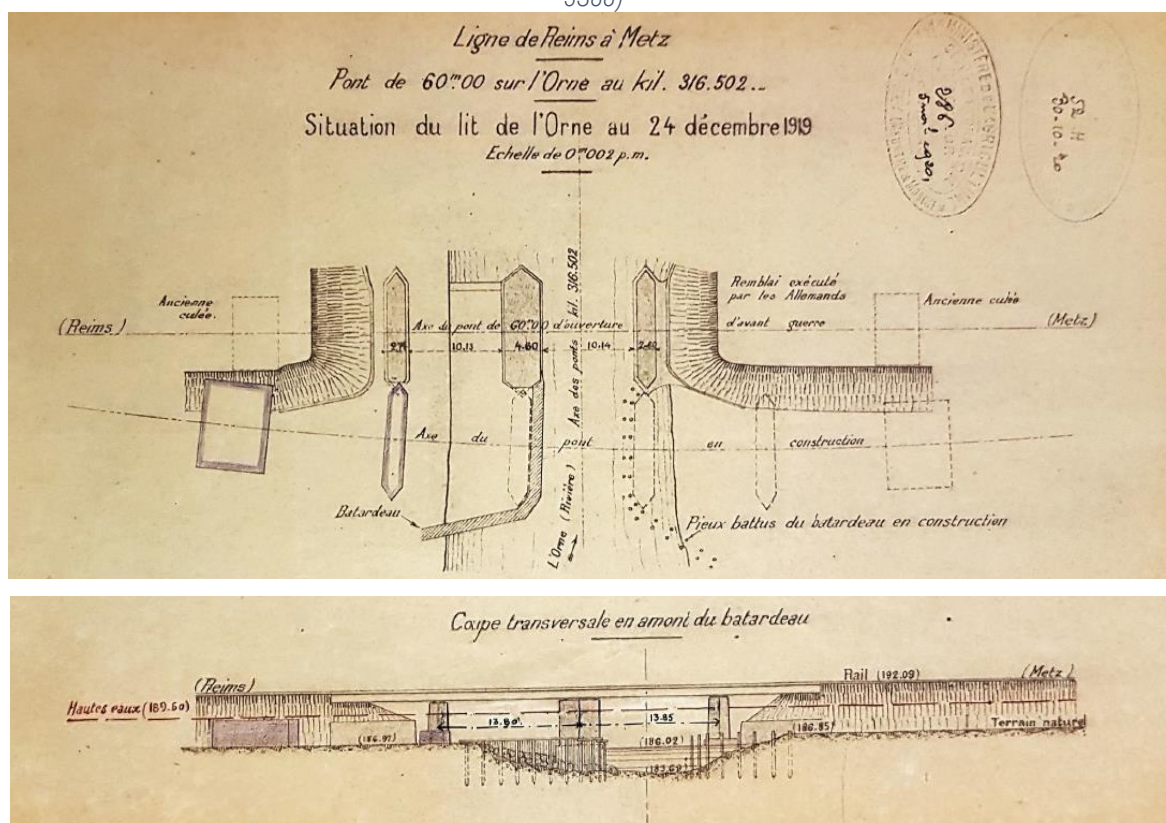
Situation du lit de l'Orne au 24 décembre 1919 au niveau du pont de Conflans (vue en plan et en coupe). (Source : AD54 3S88)
